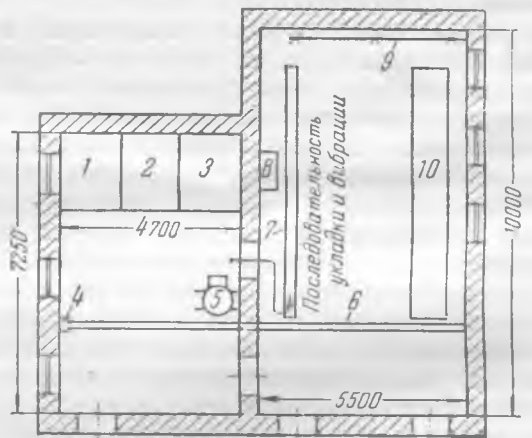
Схематический план цеха железобетонных конструкций с расстановкой механизмов.
